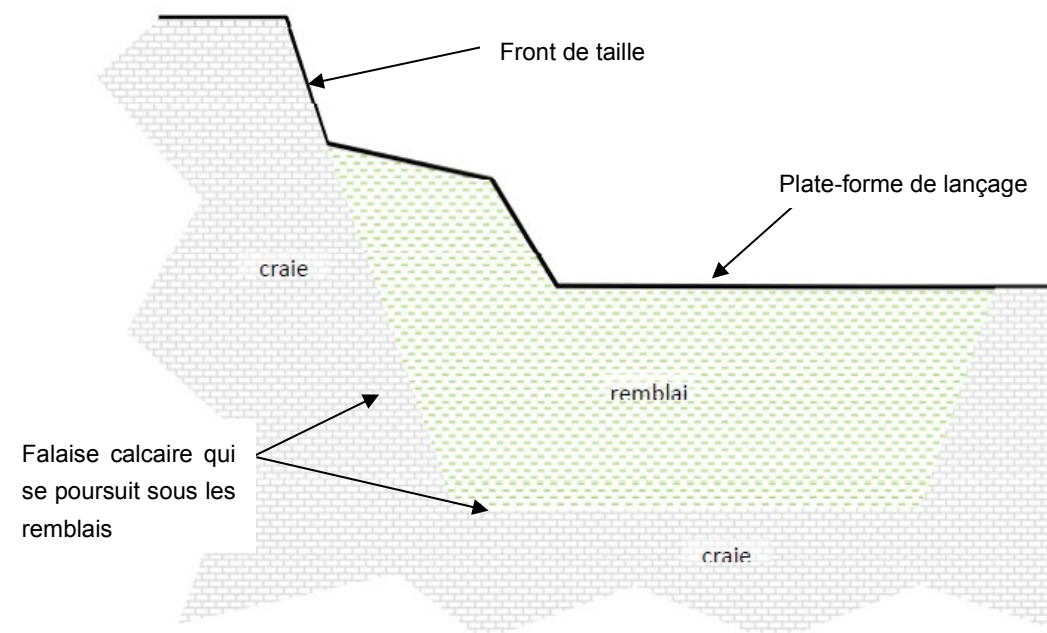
Coupe en travers de la falaise et de la plate-forme de lancement
